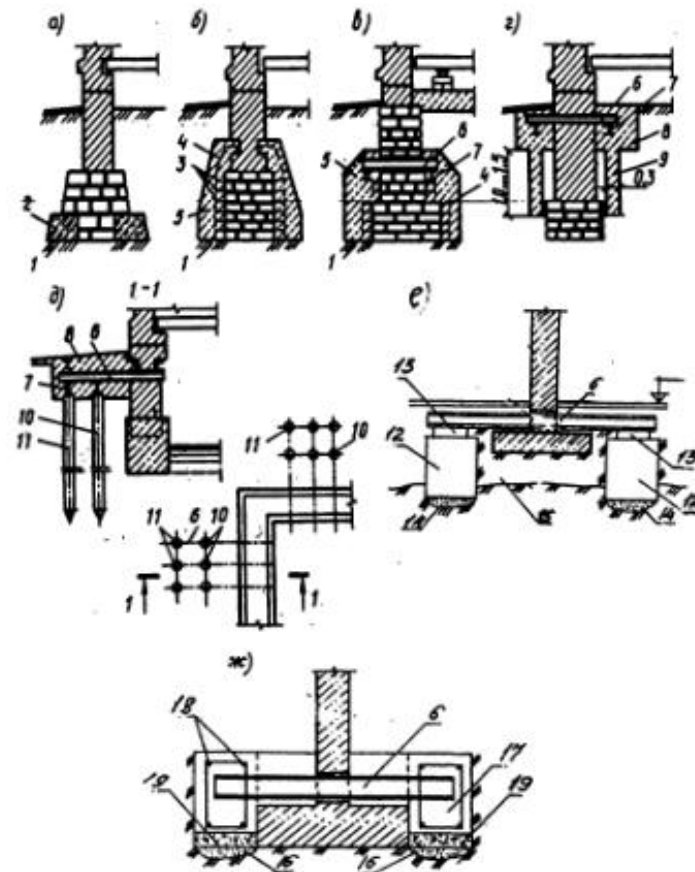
Усиление и разгрузка ленточных фундаментов: а – замена наружного ряда камней бутовой кладки подушки фундамента железобетонными балками; б – устройство железобетонной обоймы; в – передача части нагрузки на выносные опоры; г – то же, на буронабивные сваи; д – то же, на односторонне расположенные забивные сваи; ж – на железобетонные приливы; з – на втрамбованная щебенчатая подготовка; 1 – опорный железобетонный камень; 2 – забивные костыли-анкеры диаметром 16-20 мм; 3 – арматурная сетка; 4 – железобетонная обойма; 5 – разгрузочная балка; 6 – опорная балка; 7 – монолитный ростверк; 8 – буронабивная свая; 9 – забивная свая, работающая на сжатие; 10 – забивная свая, работающая на выдергивание; 11 – то же, на выдергивание; 12 – дополнительные опоры фундамента; 13 – подкладки; 14 – слой грунта с наибольшей несущей способностью; 15 – слой слабого грунта; 16 – зона уплотненного грунта; 17 – железобетонные приливы; 18 – арматурные каркасы; 19 – тощий бетон
